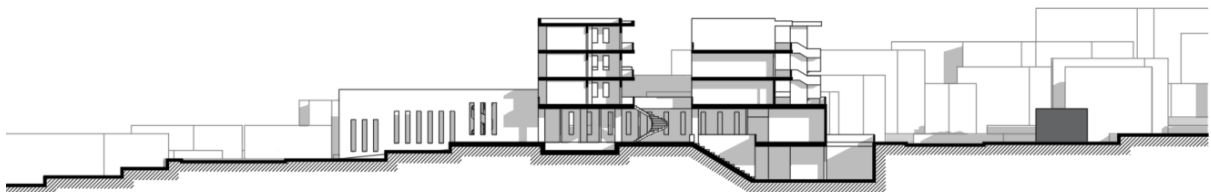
Sección B-B' - Anteproyecto 02. Elaboración propia.
